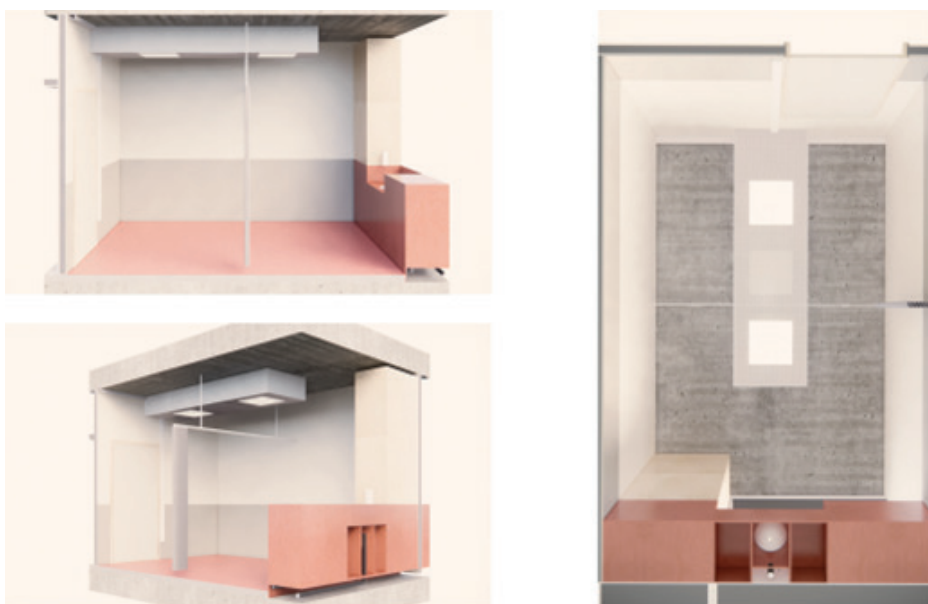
Gestandaardiseerde technisch eiland bevat alle technische uitrustingen zoals verlichting en ventilatie (Bron: archipelago architects)
